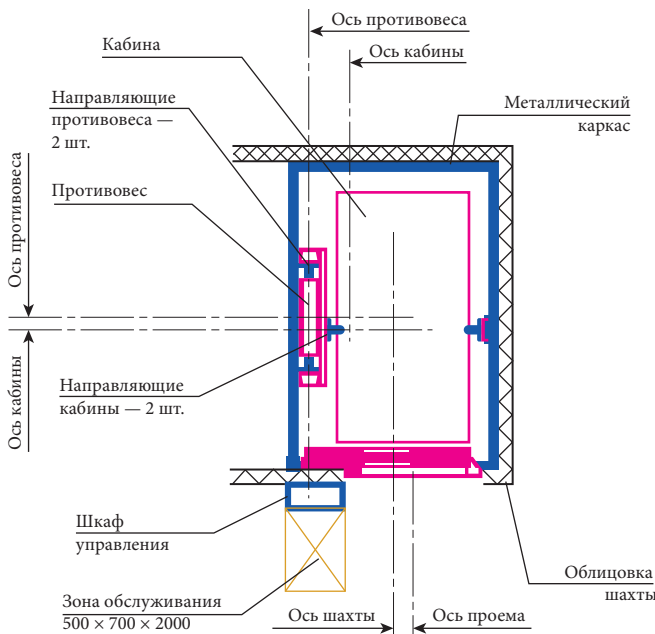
Устройство конструкции вертикального транспорта (лифта)
